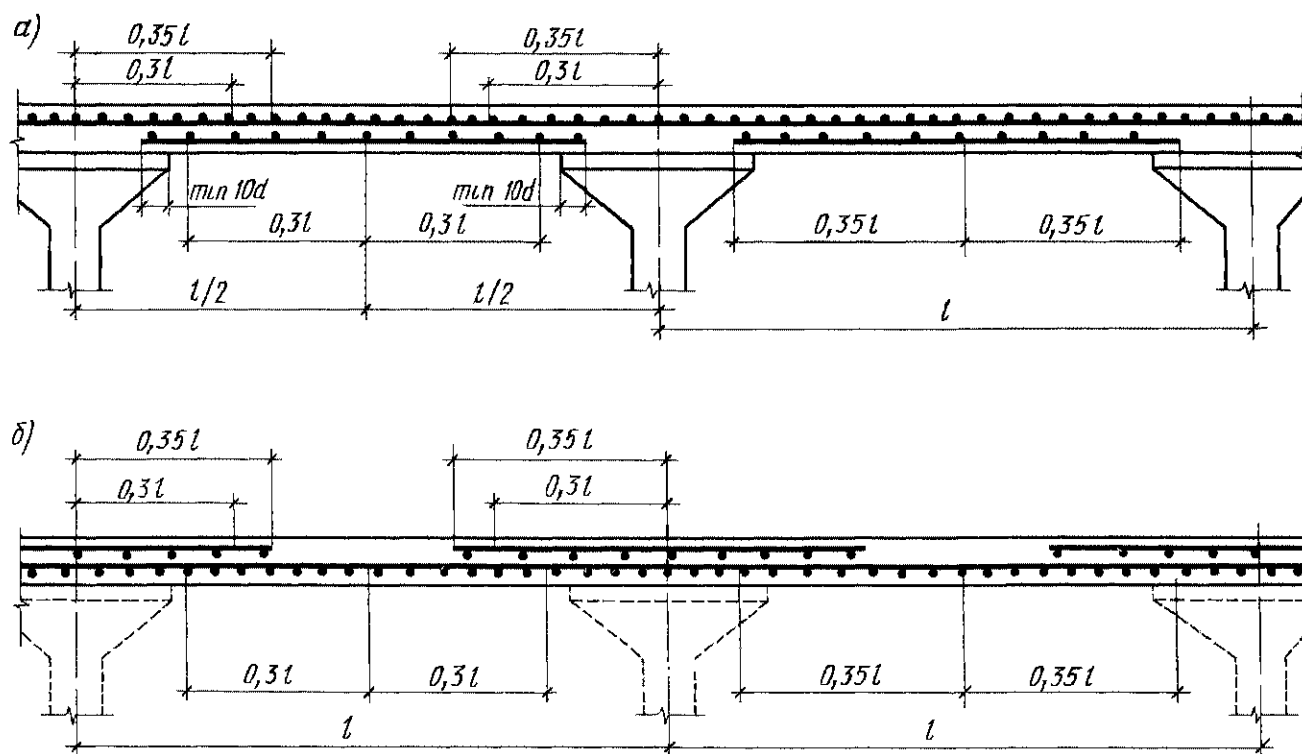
Армирование монолитного безбалочного перекрытия сварными плоскими сетками
